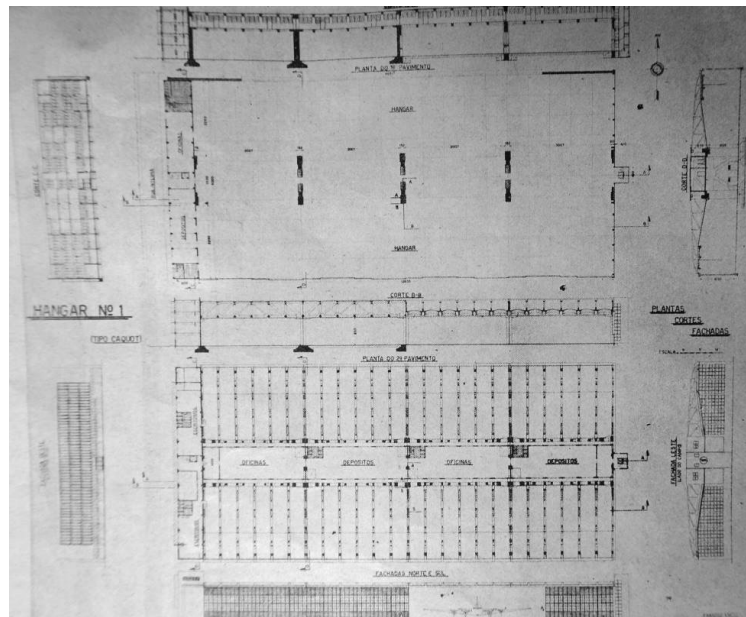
Planta-baixa, cortes e fachadas do Hangar N.1. FONTE: CONCRETO, 1945.
